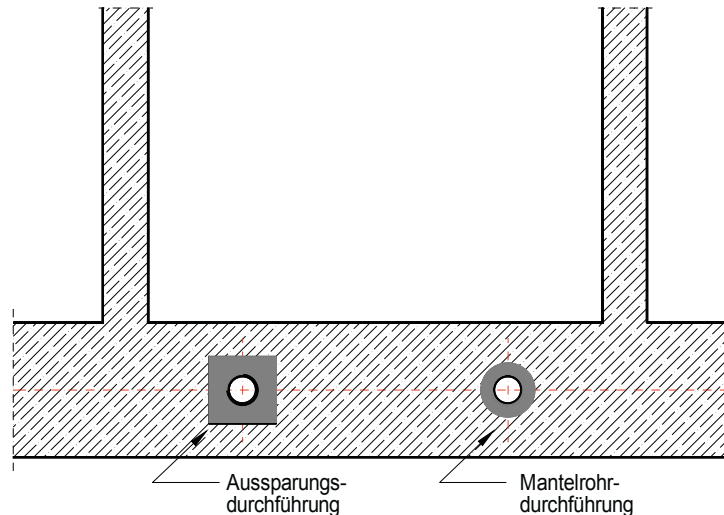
Fundamentdurchführung mit Mantelrohr oder Aussparung
